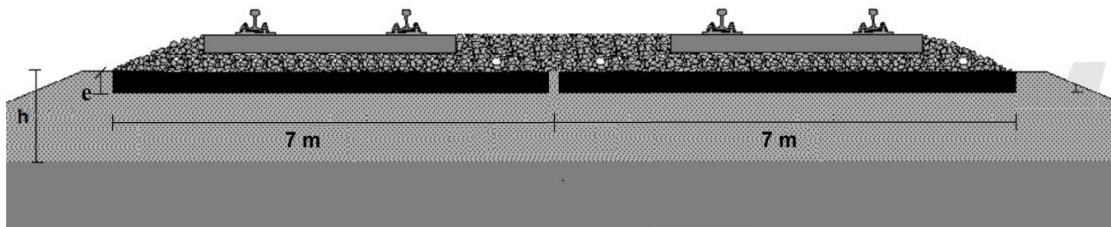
Módulo tipo losa bajo capa de subbalasto de vía doble. Fuente: Elaboración propia.
